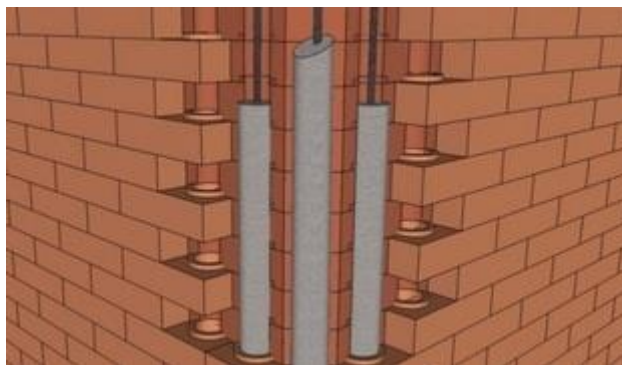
Ilustración elementos verticales, sistema constructivo Siconte
